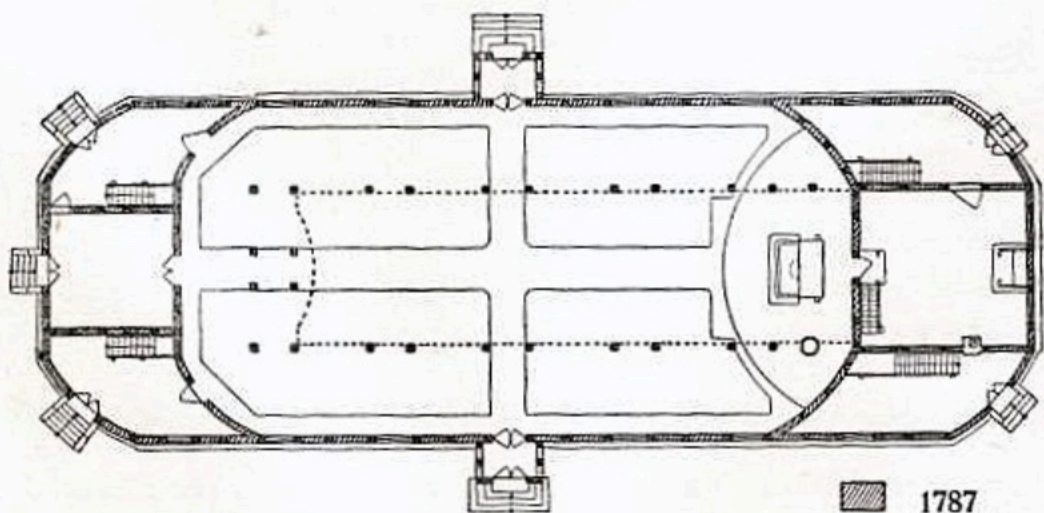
Hönigern, ev. Kirche. Erdgeschoss-Grundriß 1:400
